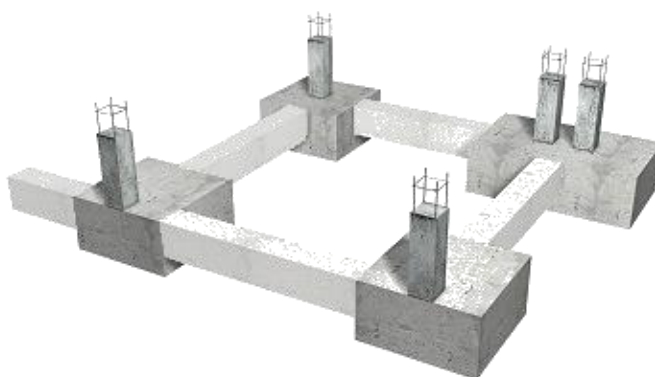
Modelo de cimentación planteado mediante zapatas
